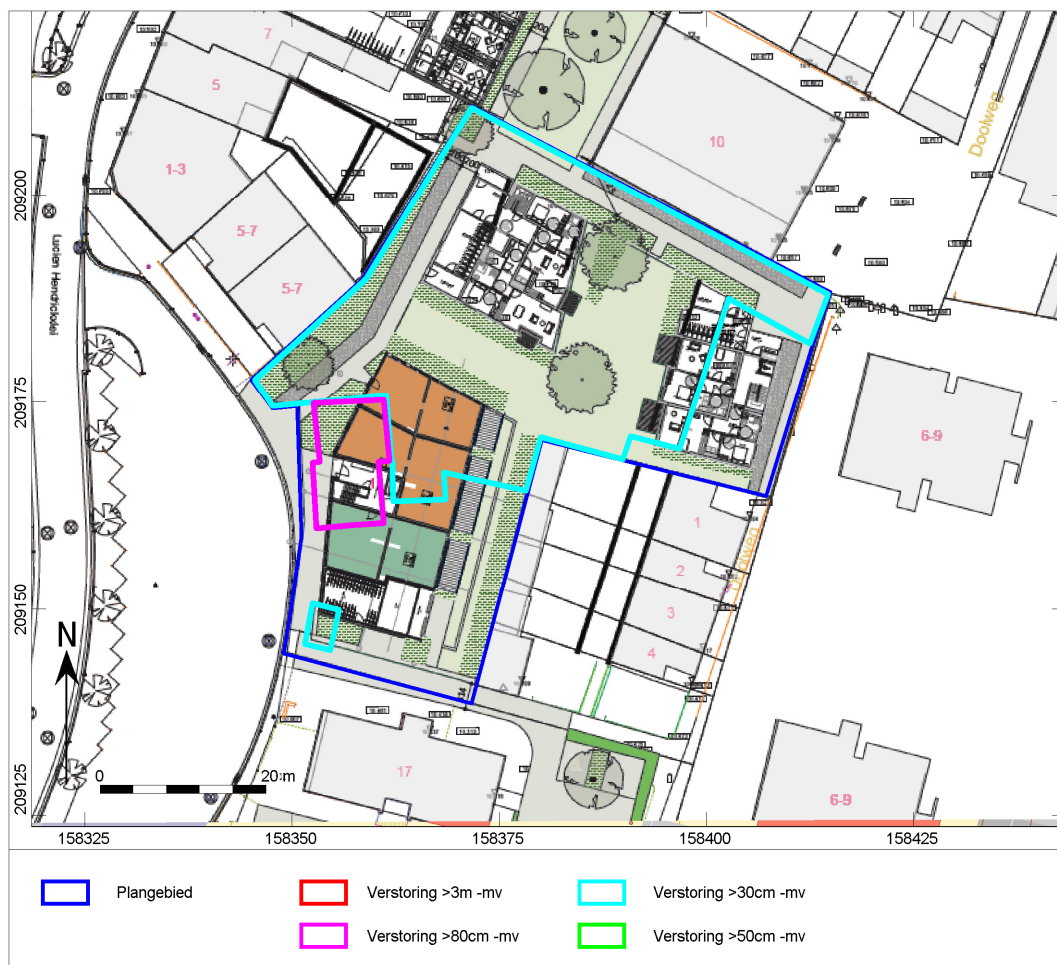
Aanduiding van de verstoorde zones op het plan van de geplande werken – deelgebied 2.
